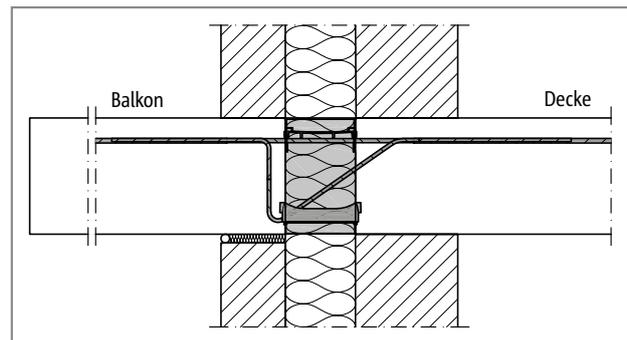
Schöck Isokorb® XT Typ K: Anschluss bei zweischaligem Mauerwerk mit Kerndämmung
